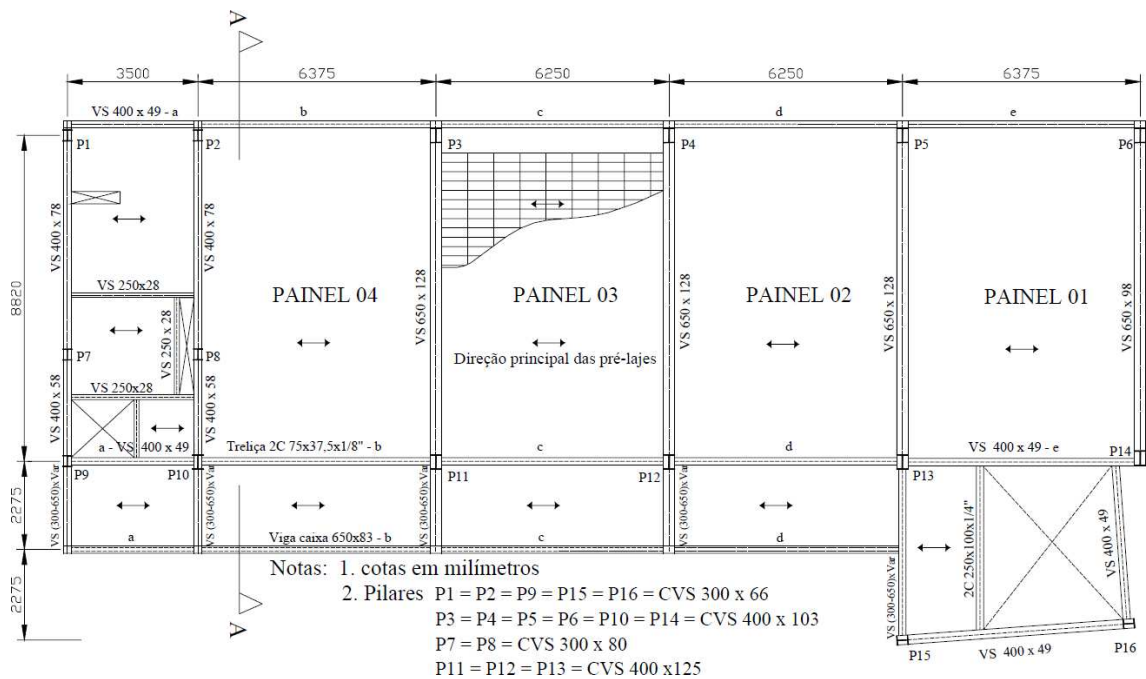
Modelo 02 - Estrutura do pavimento tipo do edifício.
